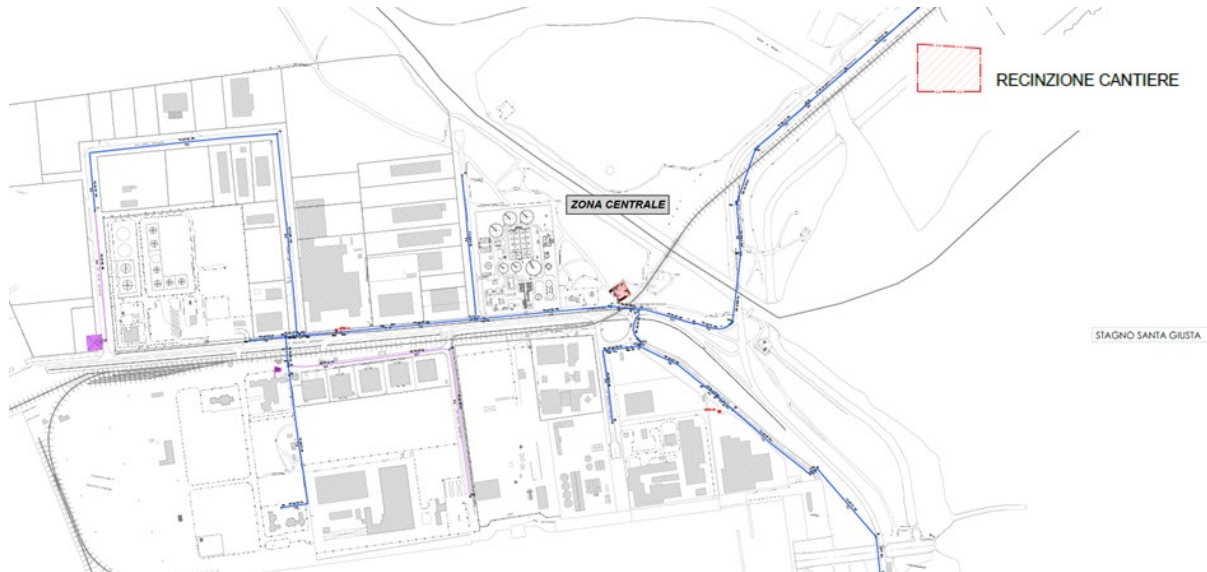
Stralcio tavola Planimetria di cantiere (el PAIN01SIAG005R00)
